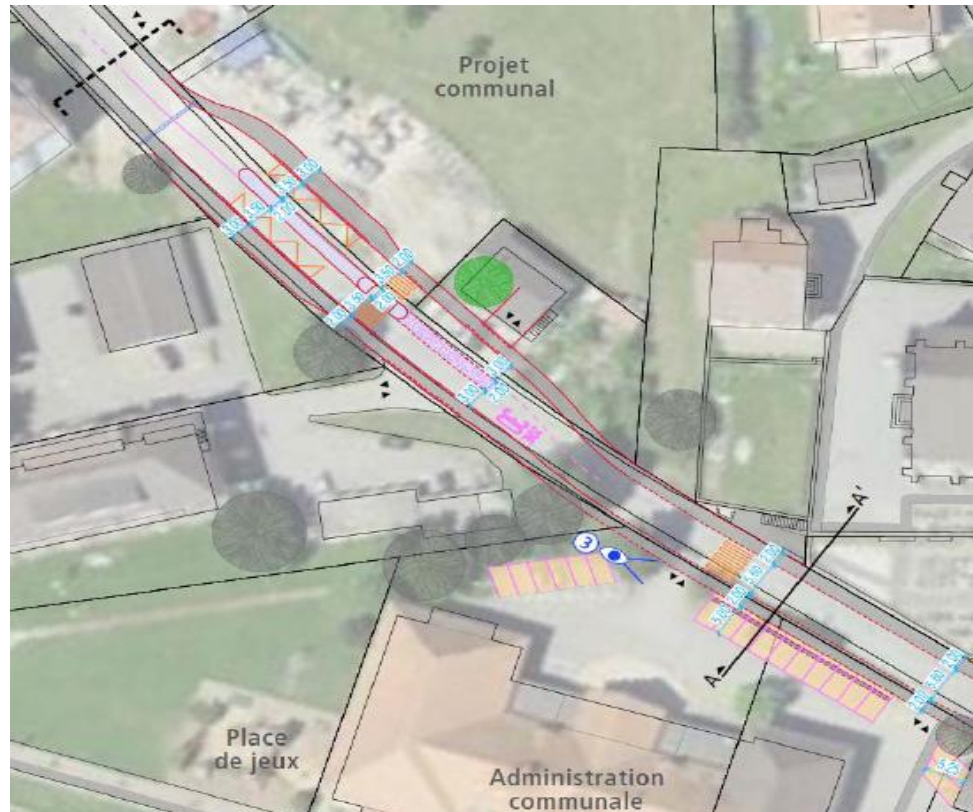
Principales interventions sur la Route de Moudon (Transitec ing. conseils SA)
